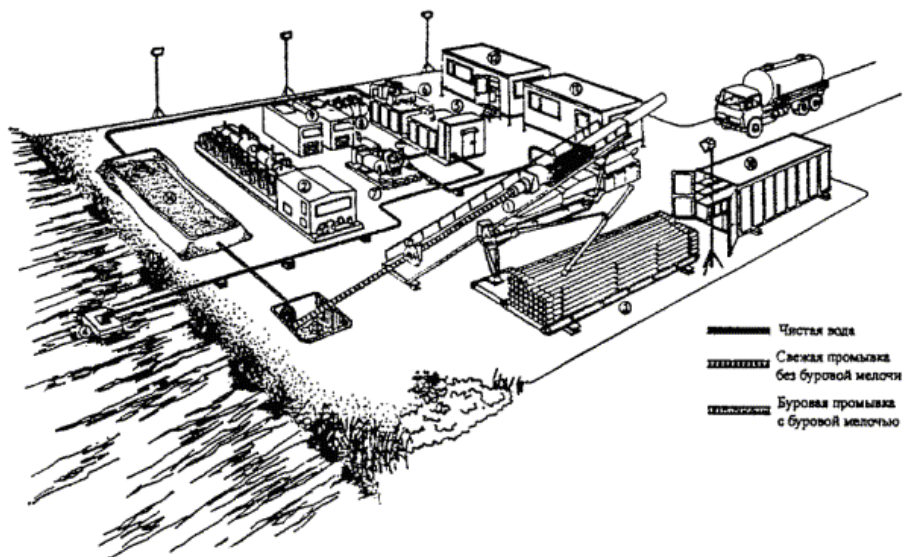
Схема размещения установки ГНБ на строительной площадке
